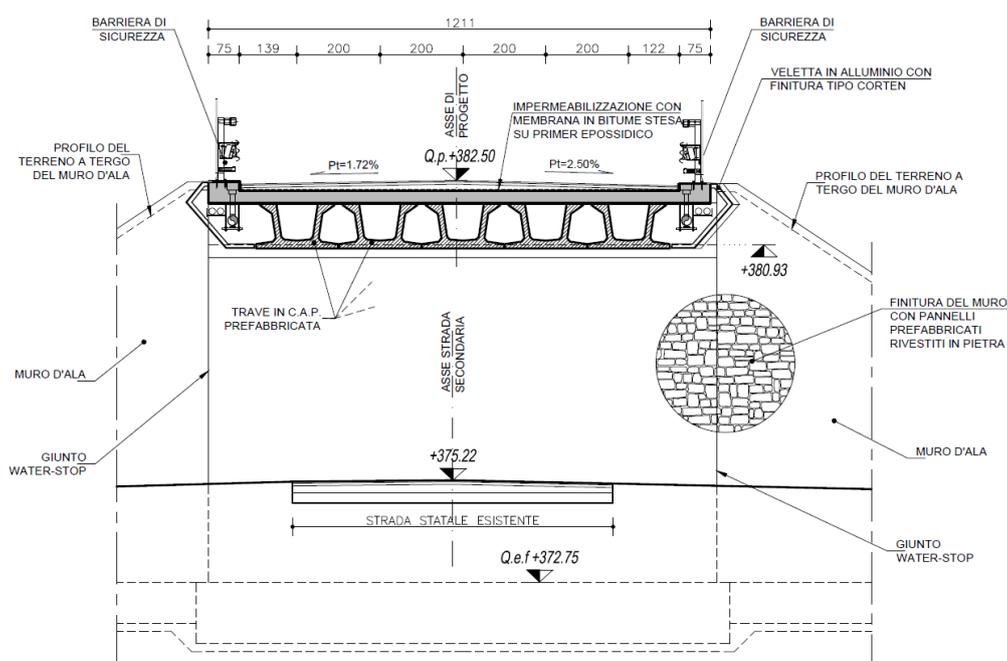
SEZIONE TRASVERSALE SOTTOPASSO PK 1+450.74
